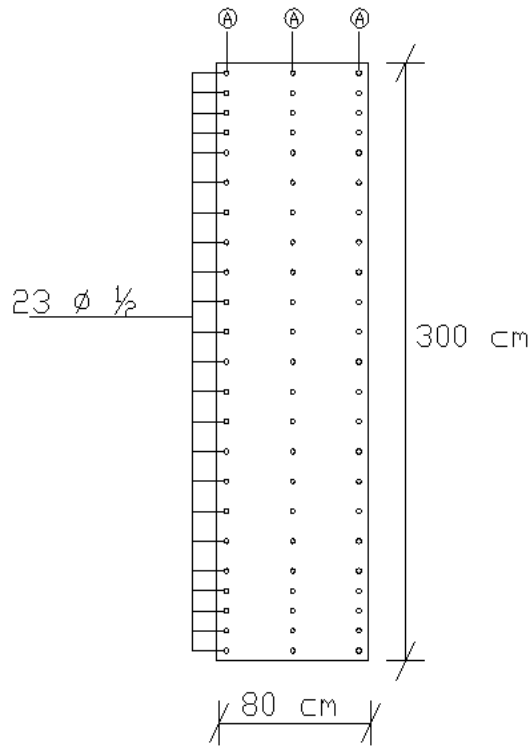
Sección transversal de muro dirección X nivel 2.
